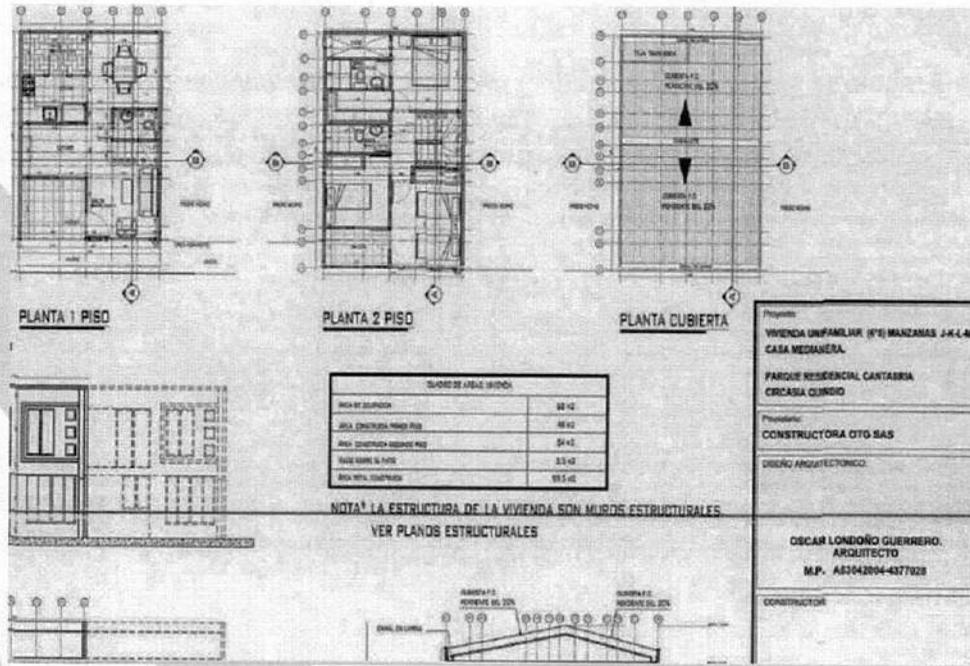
Plano arquitectónico aprobado predio 63-190-01-01-0428-0007-000
